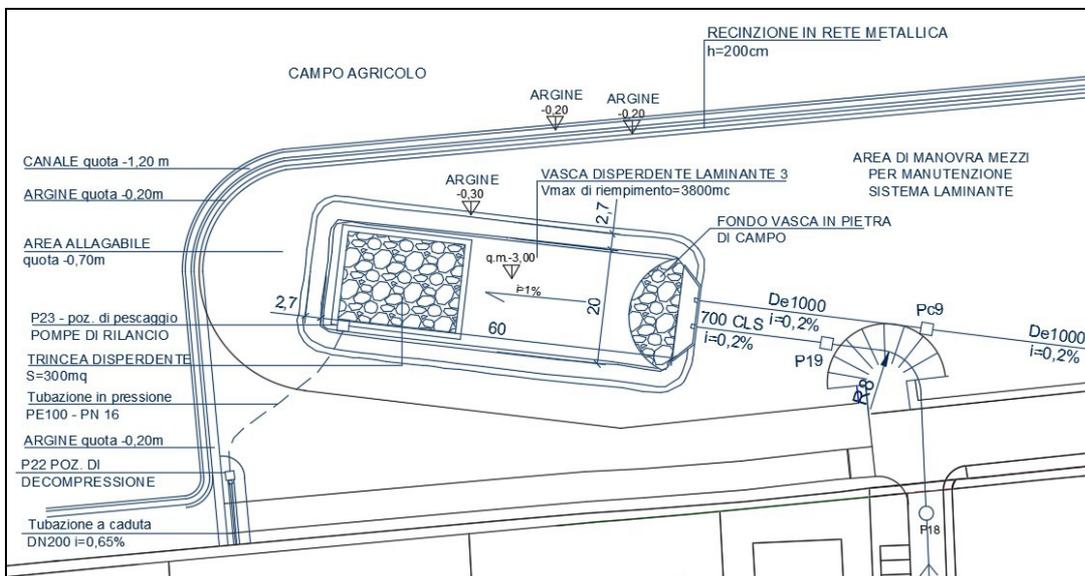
Dettaglio della vasca di laminazione (fonte: studio "Protec Engineering s.r.l.")
